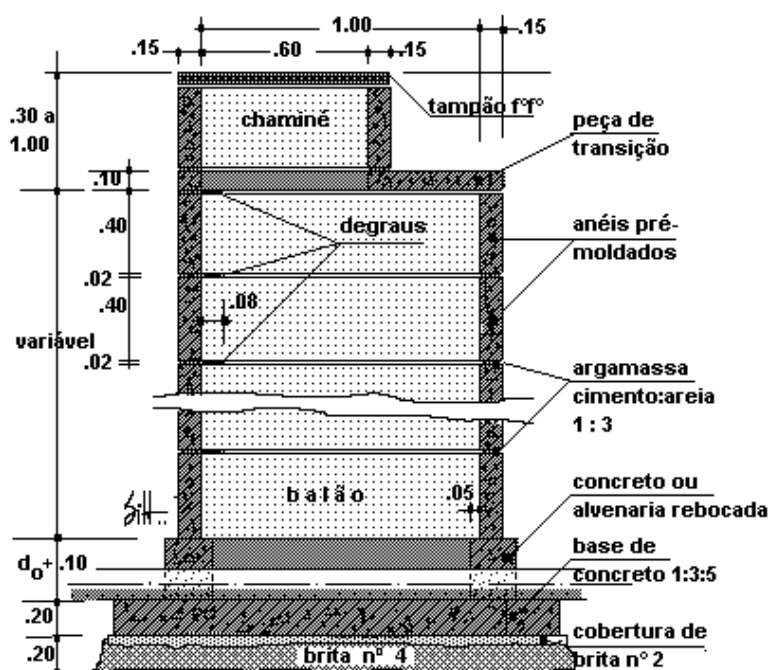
Representação de um PV em uma planta de cálculo ou execução .
